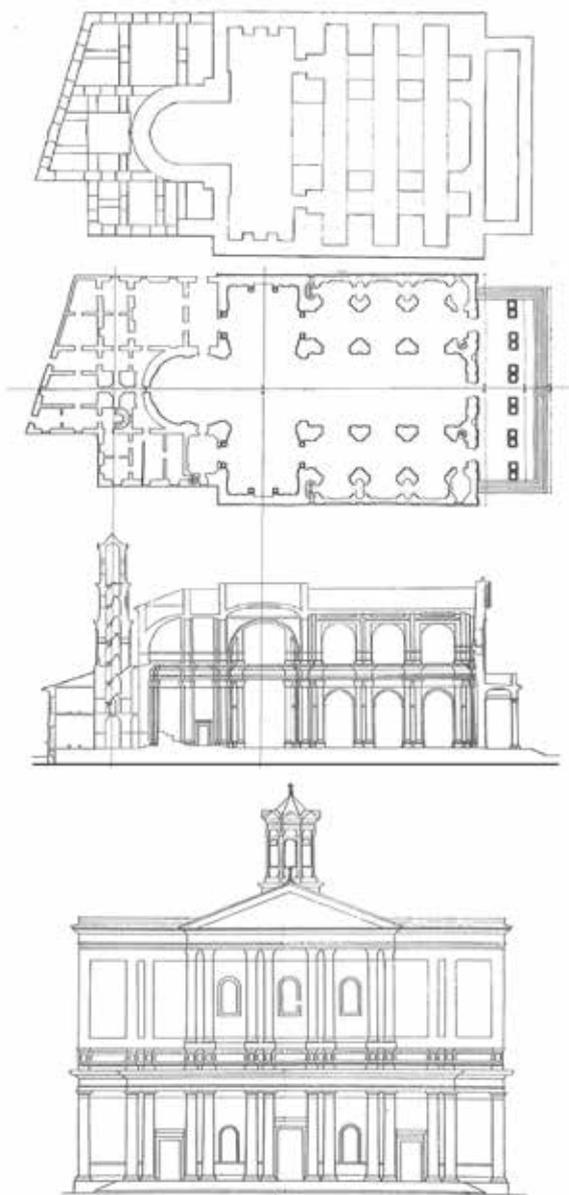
Carlo Tonelli, progetto per la chiesa di Testaccio (1887): piante delle fondazioni e alla quota di calpestio della chiesa, sezione, facciata.
